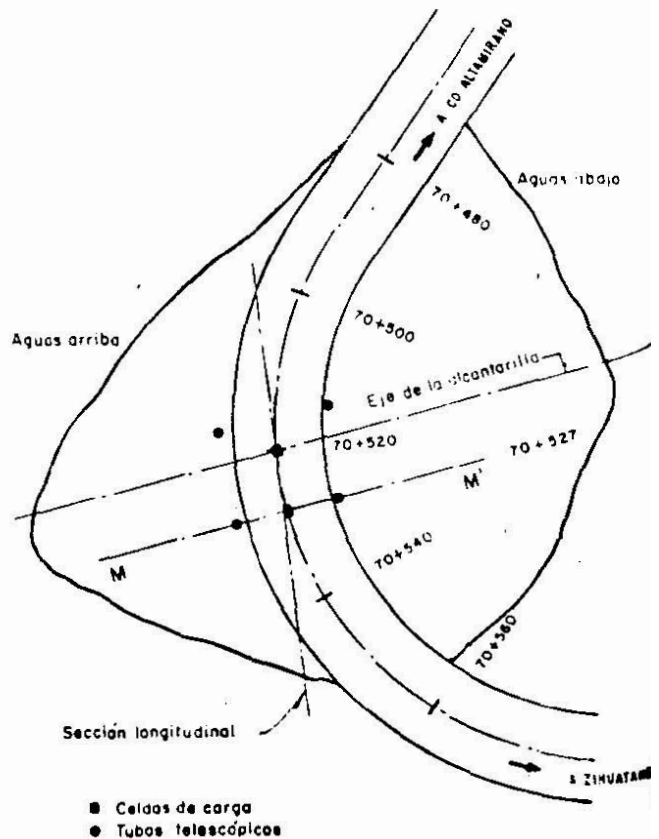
Planta de localización de la instrumentación dispuesta en el pedraplén "La Chachalaca".
